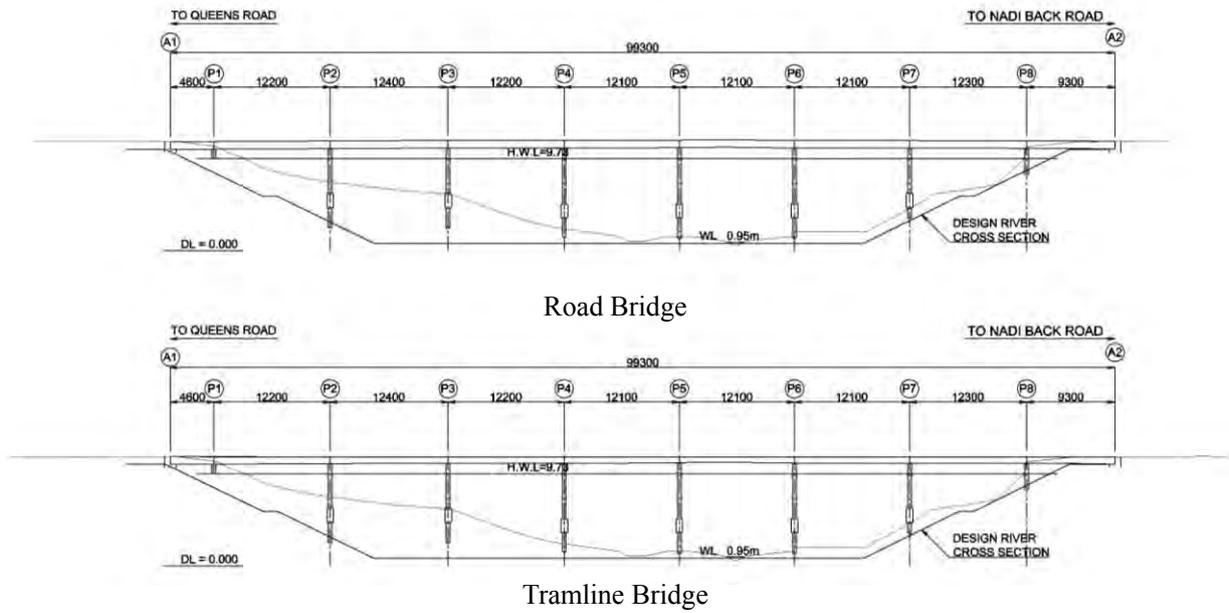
既設橋側面図(Old Queens Road Bridge) Source: JICA Study Team
